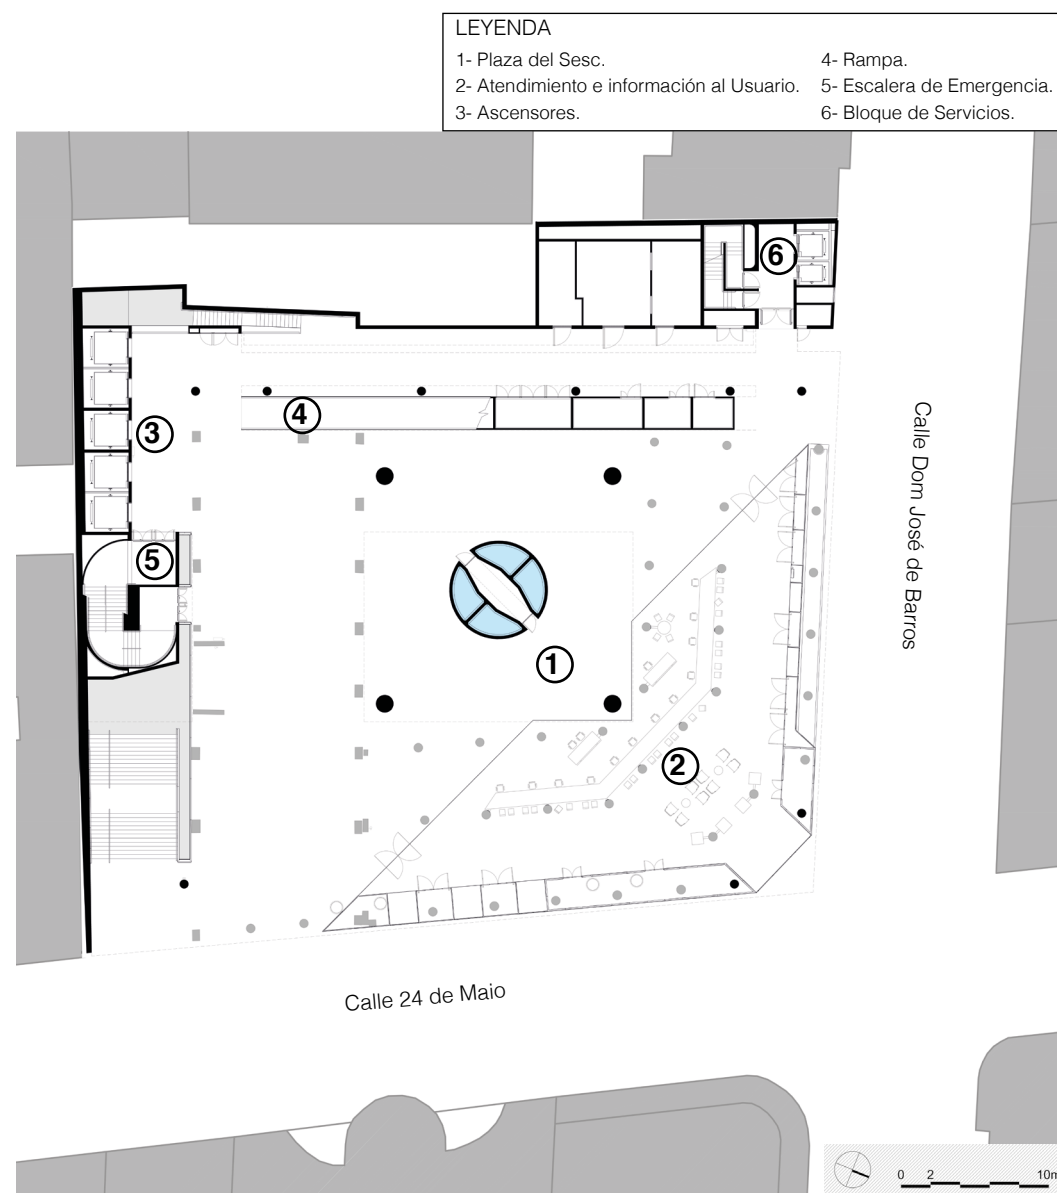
Planta Baja del Sesc 24 de Maio. (Autoría propia. 2021. Base: MMBB Arquitectos).
